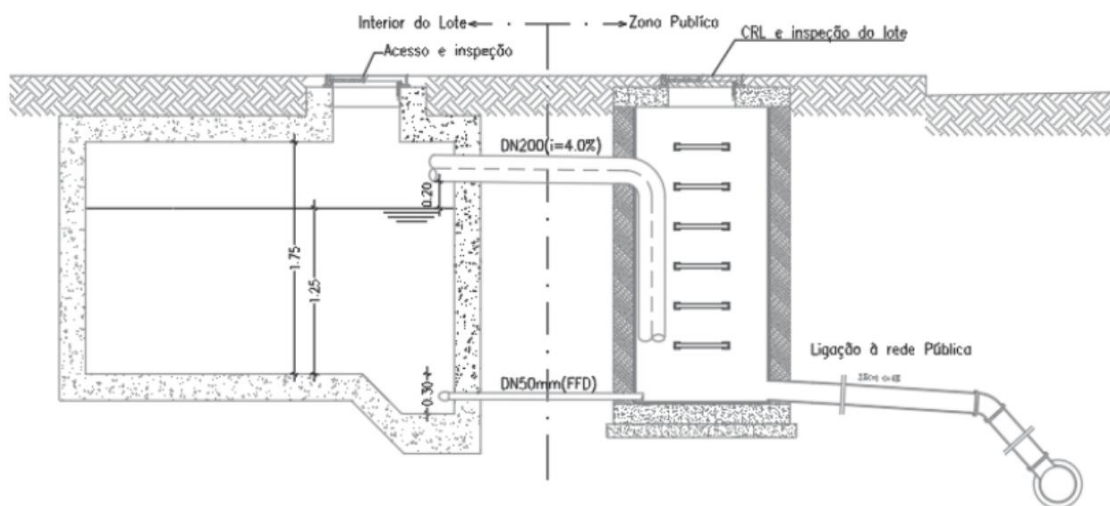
Corte tipo das bacias de detenção a instalar nos lotes (PROJEGUI).
